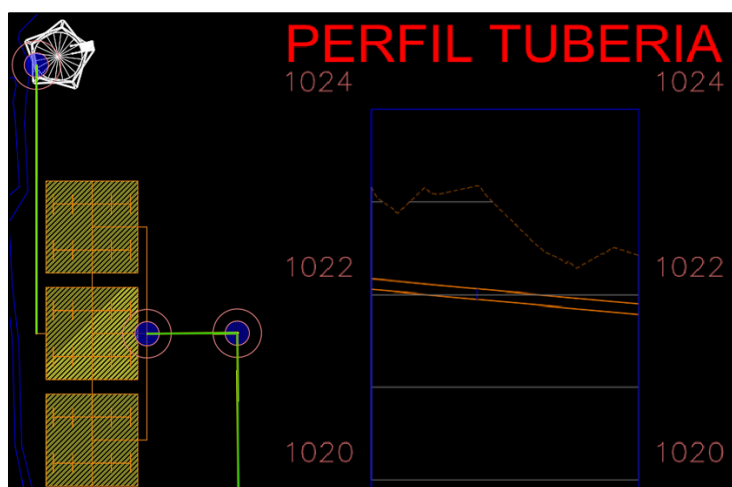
Vista en planta y perfil de tubería de tanque.
